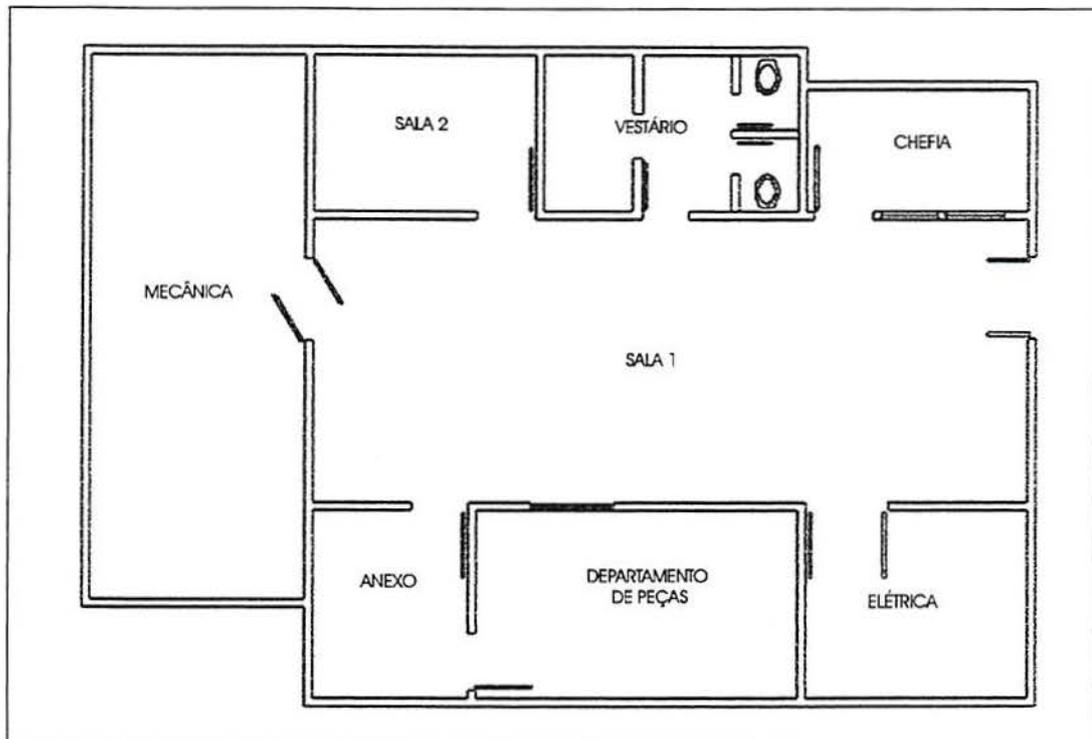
Planta da Oficina com Responsáveis pelo 5S's
